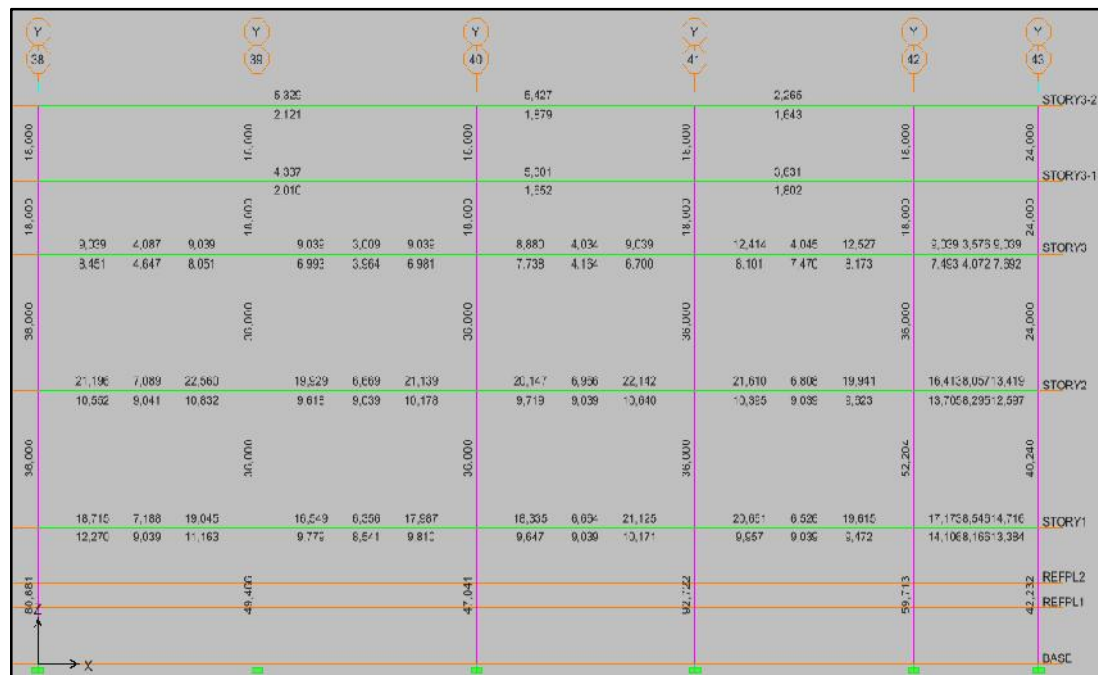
Acero en vigas pórtico Y, Consulta Externa II
